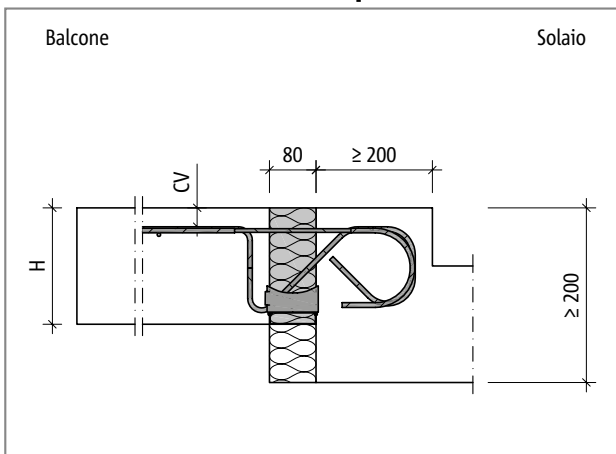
Schöck Isokorb® tipo K10S-UZ – K60S-UZ: balcone con innalzamento di quota e isolamento esterno
